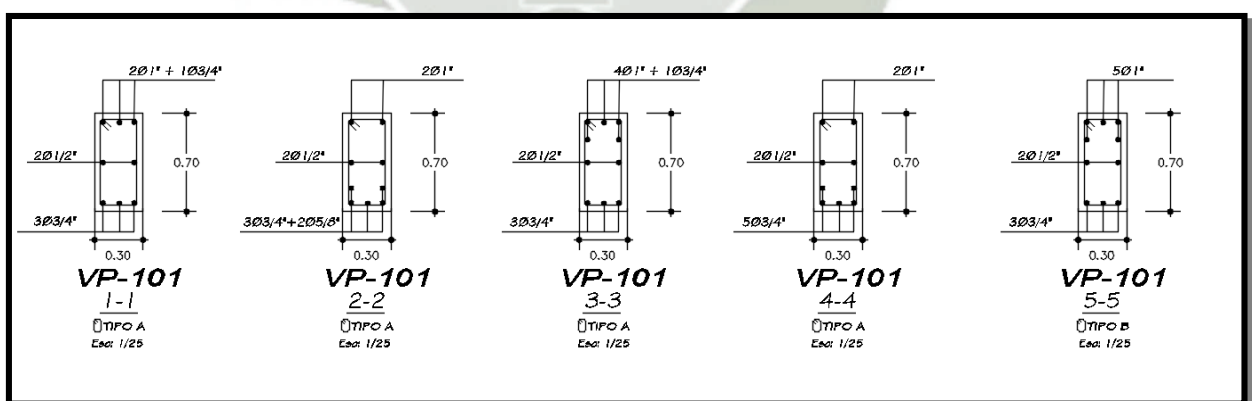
B: Cortes Transversales de la Viga VP-101
